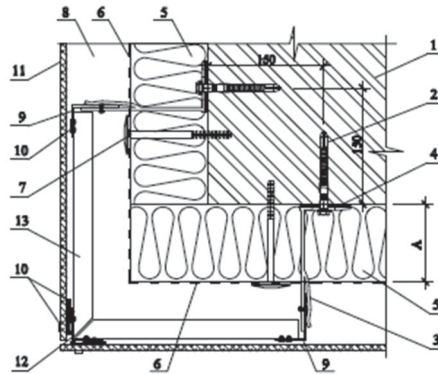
Конструктивна схема влаштування теплоізоляції по зовнішніх кутах будівлі
